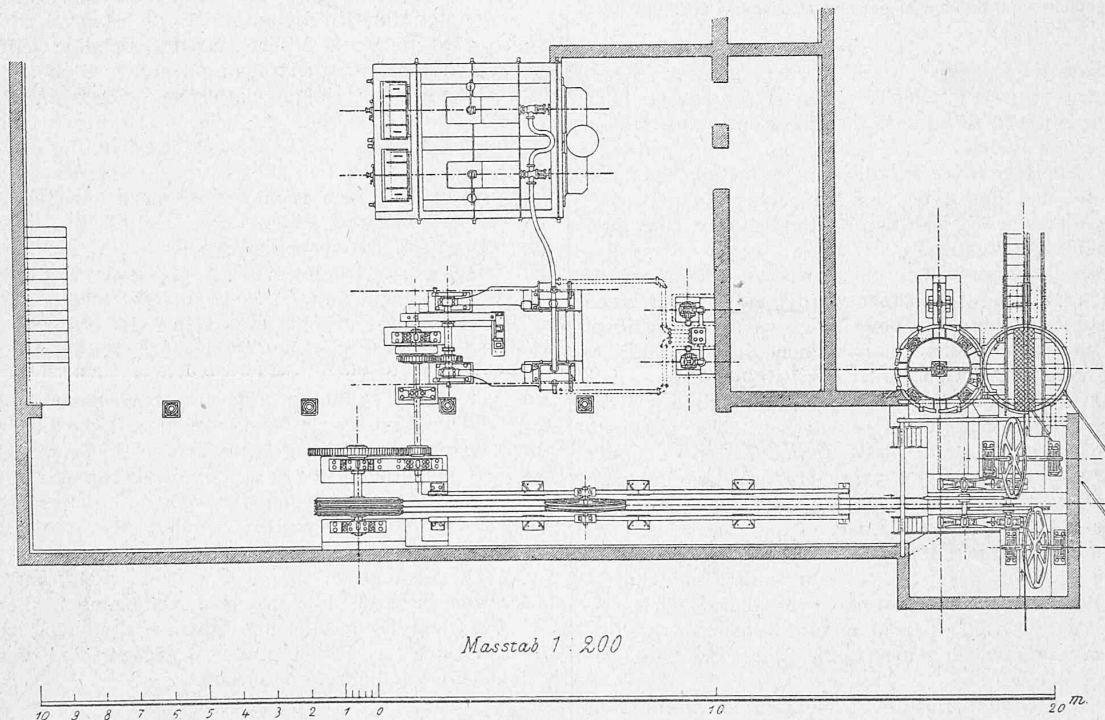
Grundriss des Maschinenraumes in Clay-Street zu San Francisco.
